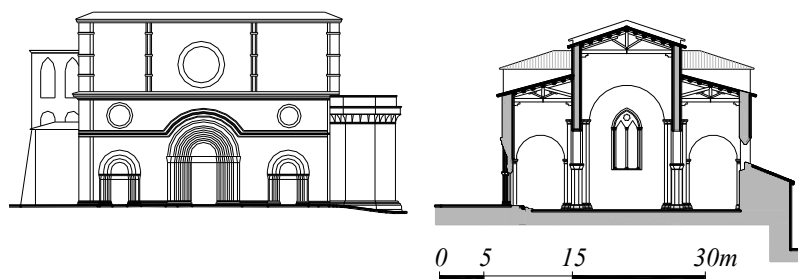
Basilica di Collemaggio: Prospetto facciata e sezione trasversale in corrispondenza dell'arco trionfale
